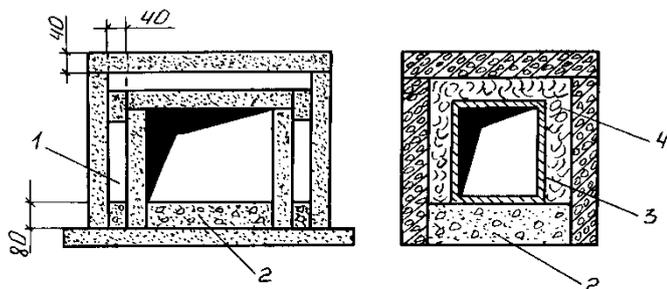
Устройство вентиляционных сборных коробов на чердаке: *а* – из шлакогипсовых плит; *б* – из бетонных плит; 1 – воздушная прослойка; 2 – шлаковая заливка; 3 – металлический воздуховод; 4 – утеплитель.
